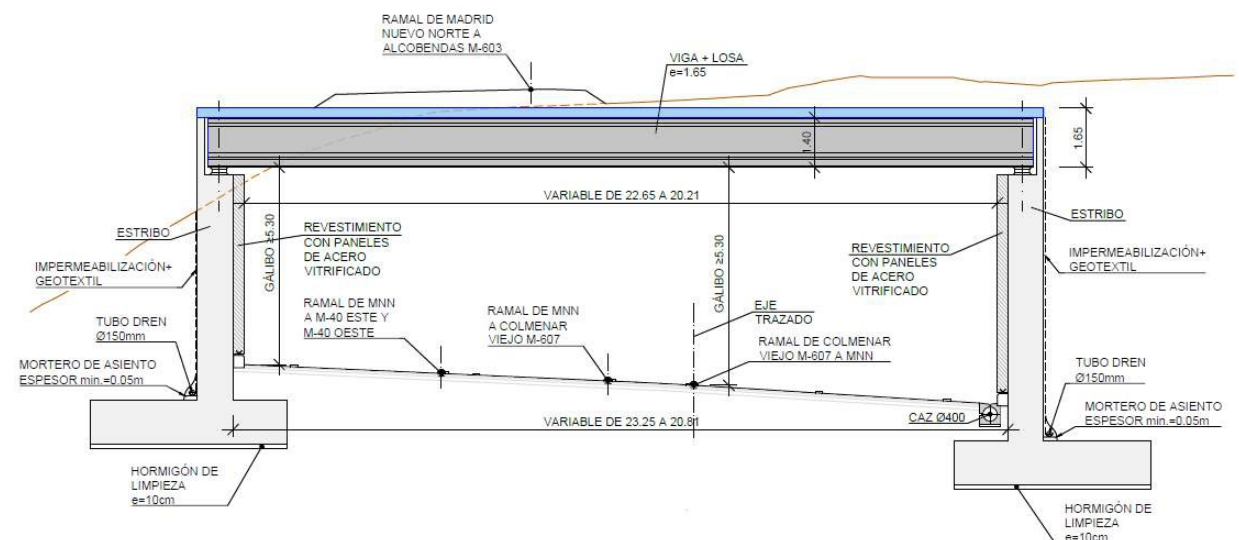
Sección tipo con muros estribos y dintel con vigas prefabricadas. Falso túnel Sur (1A, 2A y 3A)
